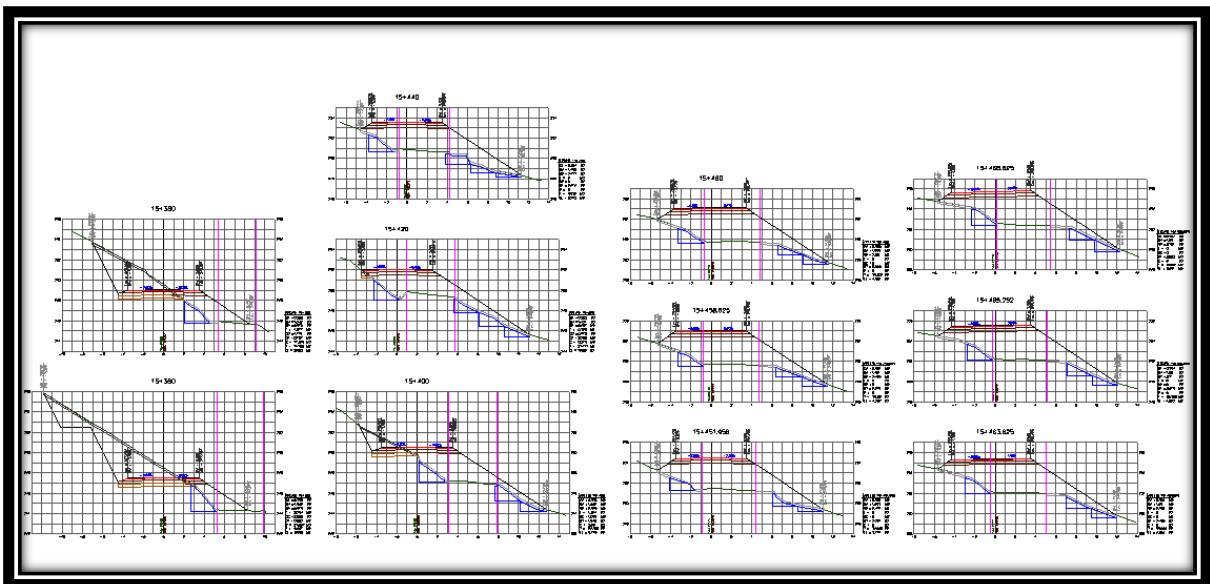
Secciones de construcción del km 15+360.000 al km 15+468.625.
